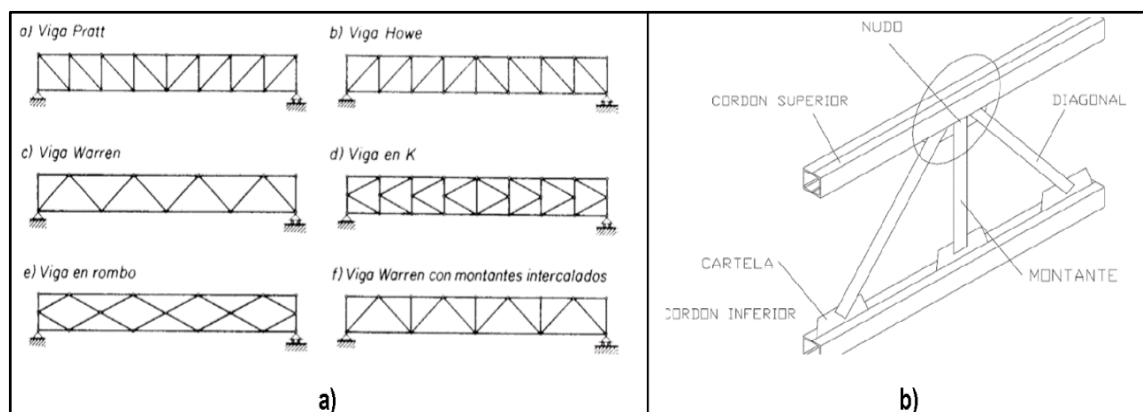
a) Tipos de viga; y b) partes de una viga en celosía. Vinnakota (2006)
